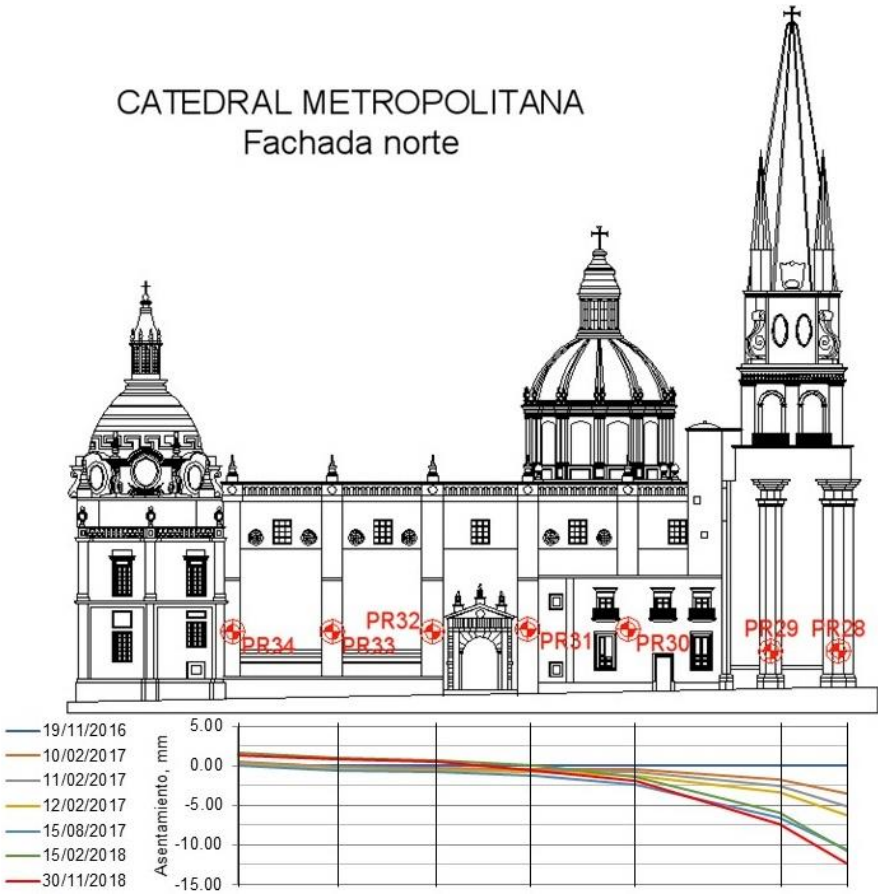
Perfil de asentamientos en la fachada norte. Catedral Metropolitana.
